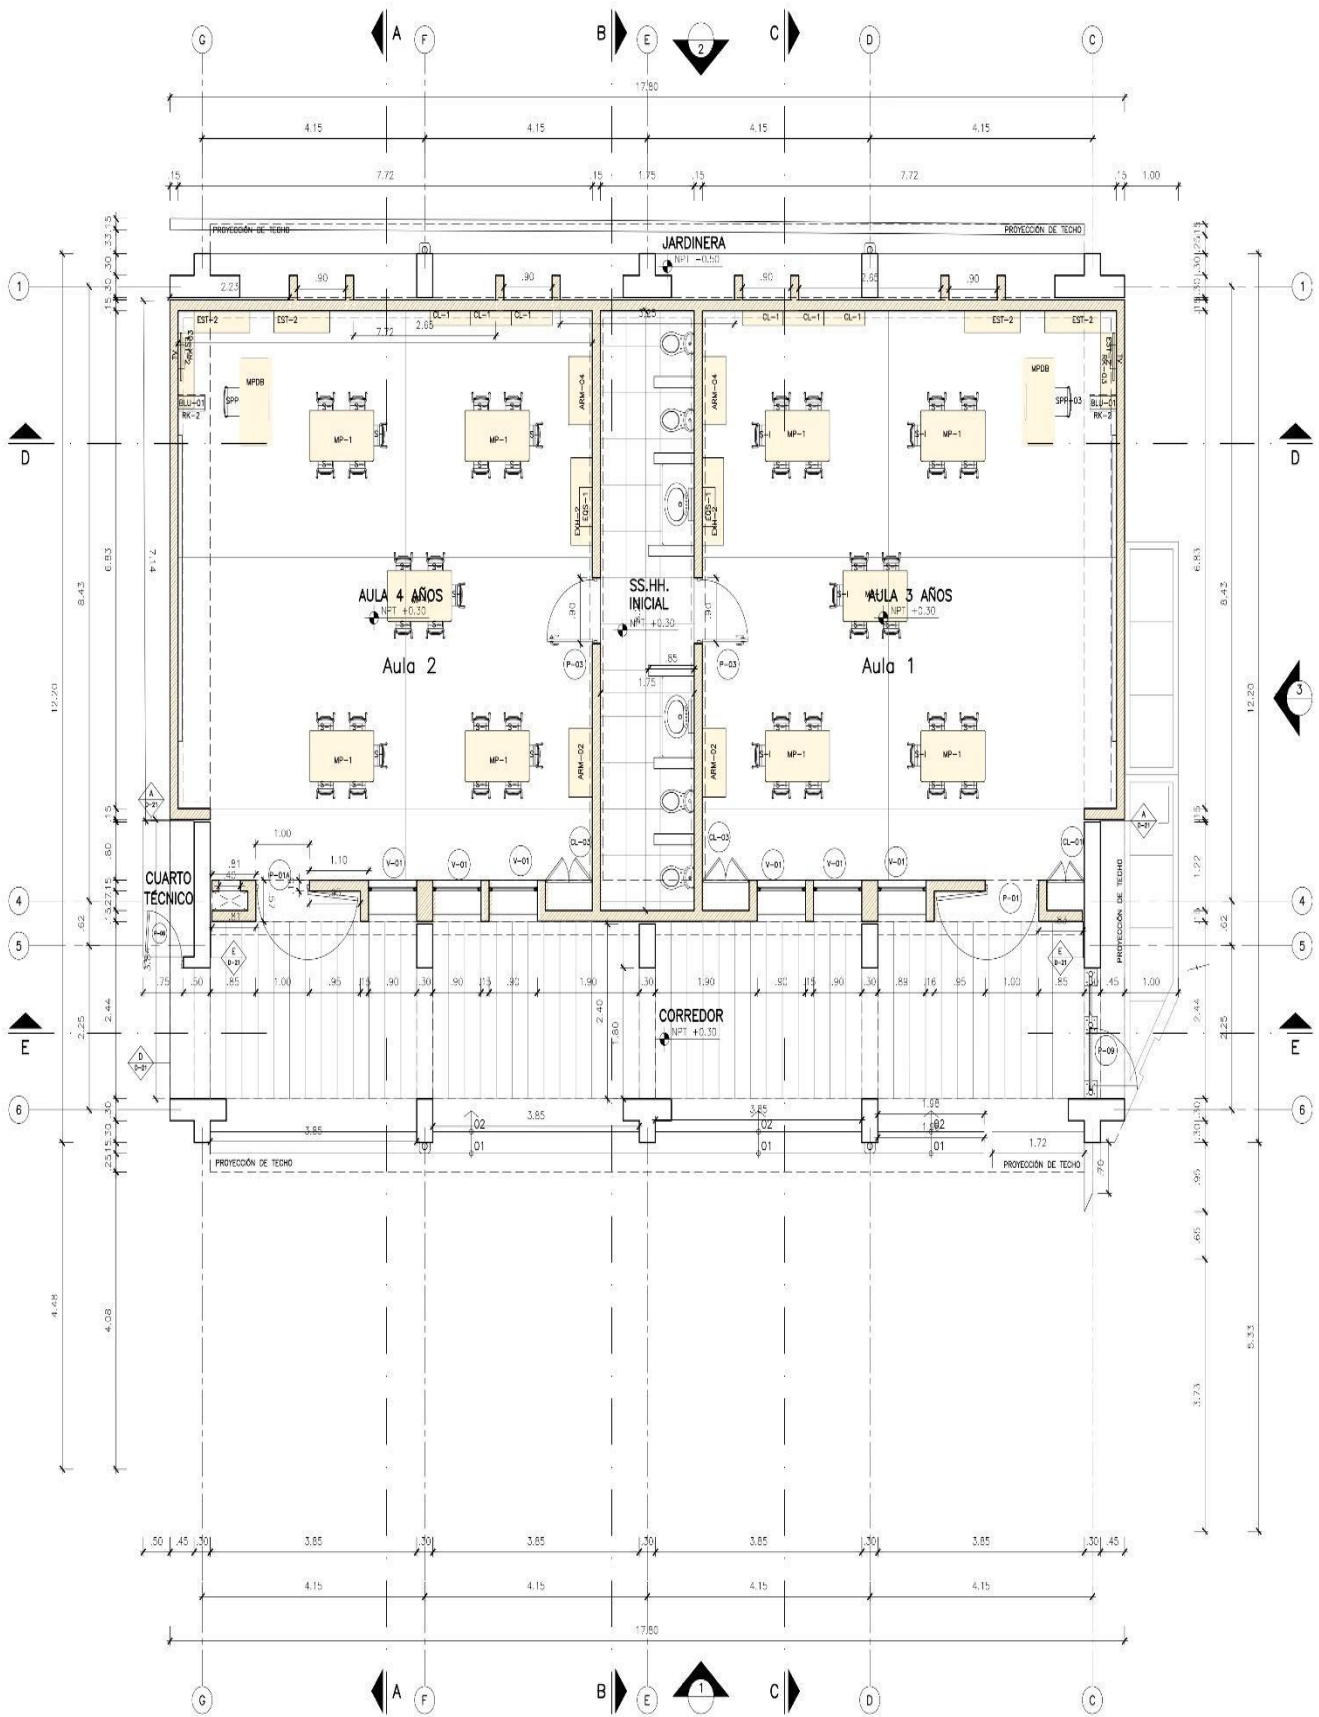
Modulo 1, distribución arquitectónica, primer piso
